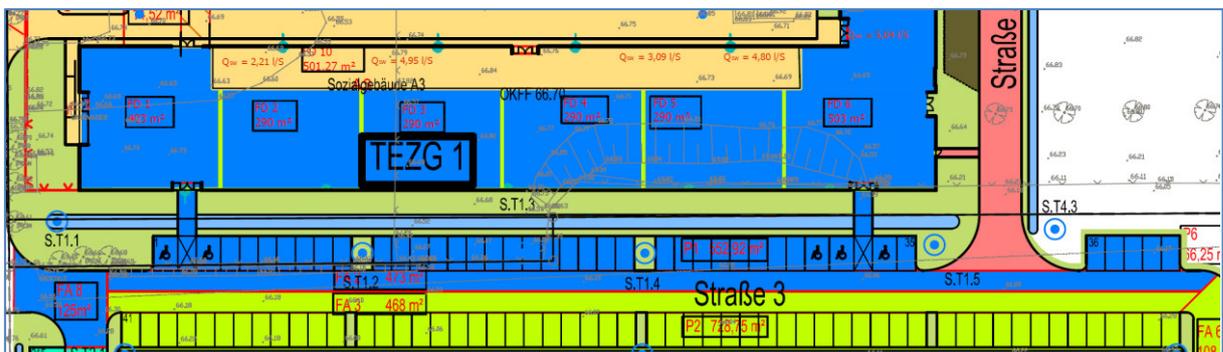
Lageplan Teileinzugsgebiet 1 (TEZG 1)
